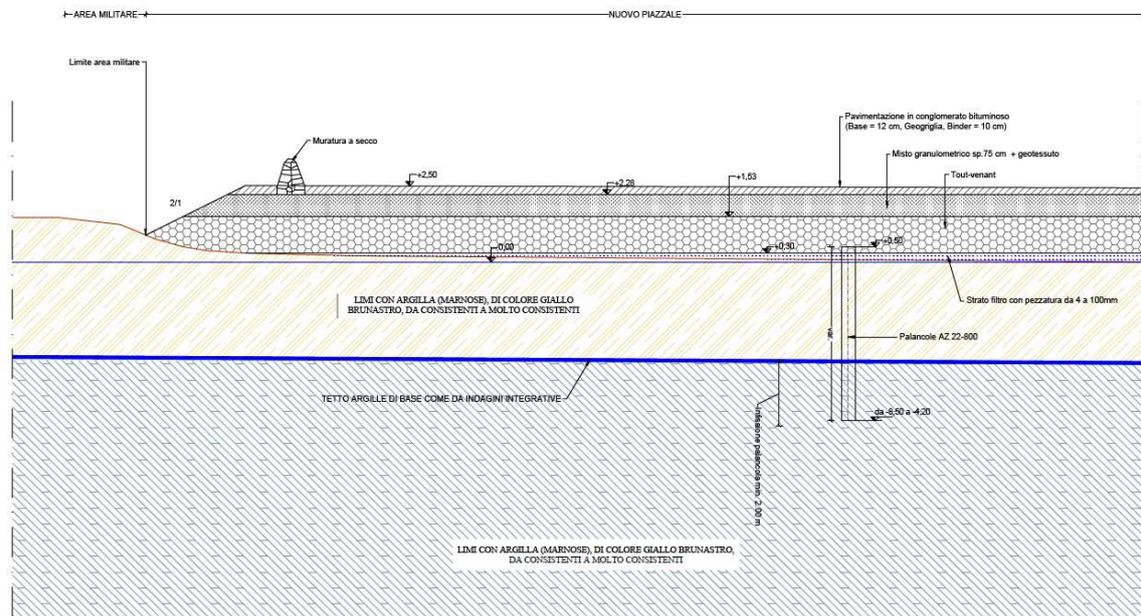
Confinamento colmata a terra - Sezione Tipo
